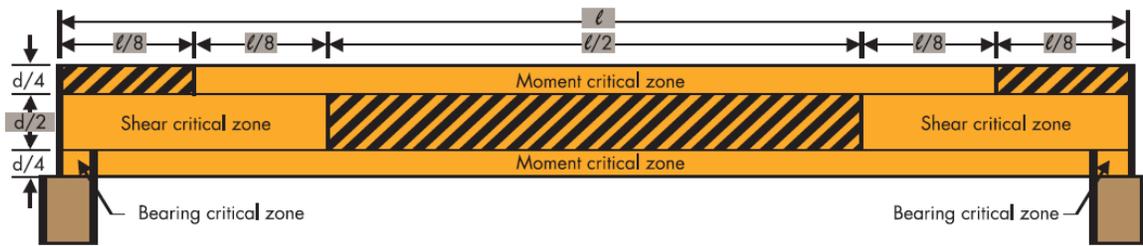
zona de menores esfuerzos en vigas (Rosboro, 2013).
